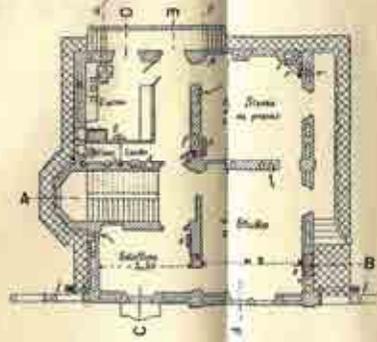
Pianta del piano terreno (Scala 1:200)
